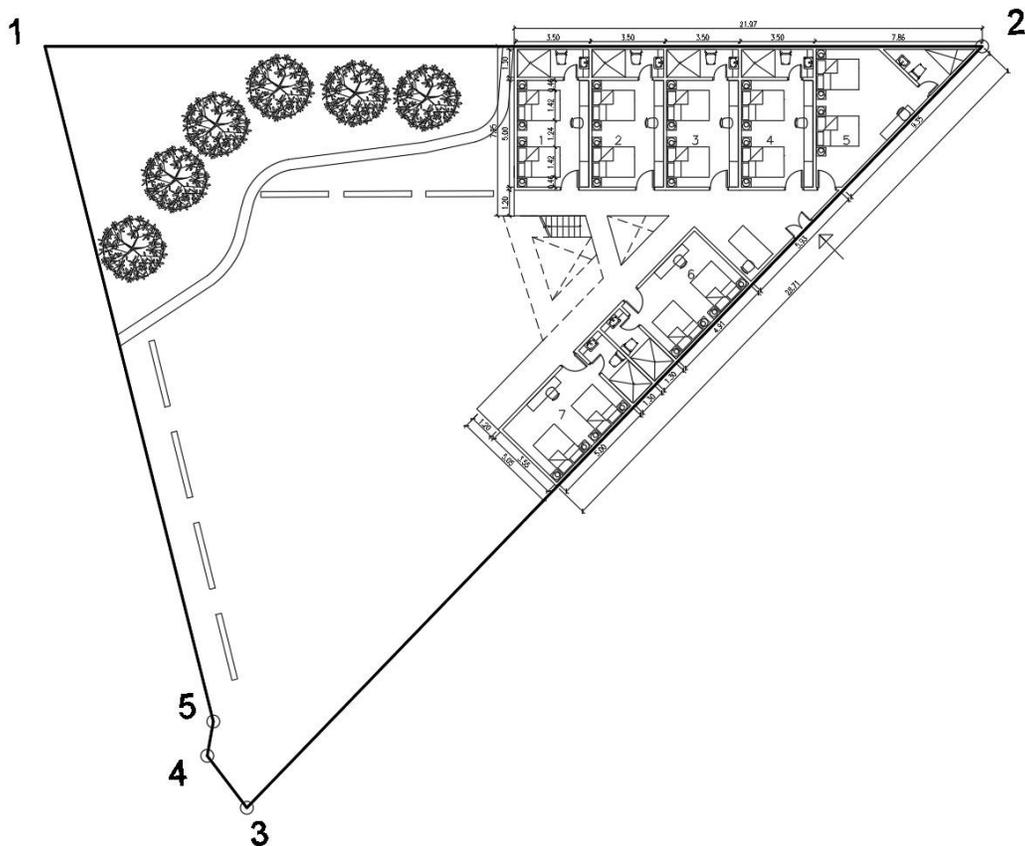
Planta Arquitectónica de Hotel Santa Rosa
